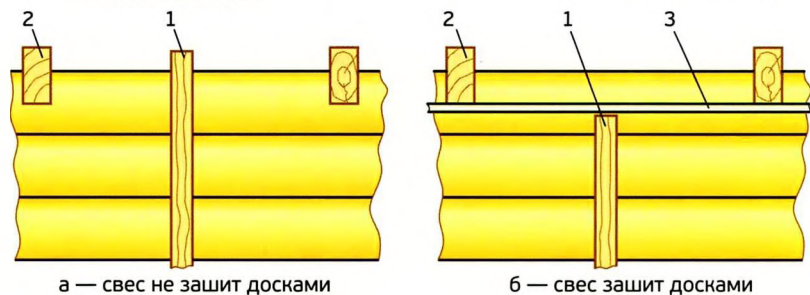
Варианты сопряжения стены с карнизом: 1 — доска обрешётки; 2 — балка перекрытия; 3 — доски подшивки карниза.
